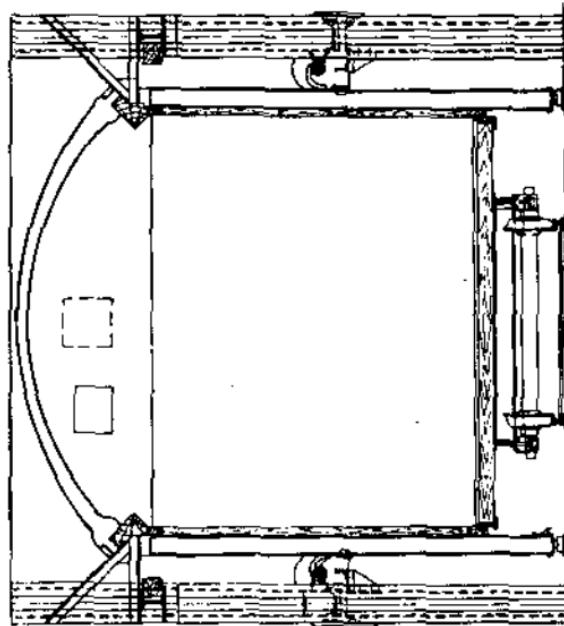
Разрез железобетонной камеры Бескова большой мощности.
